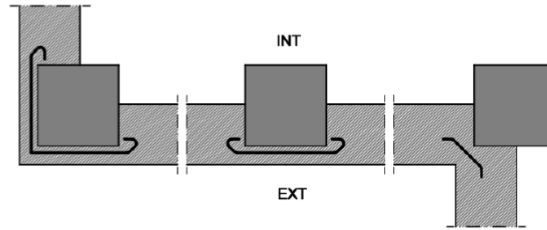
Ejemplo de encuentro de la fachada con los pilares
